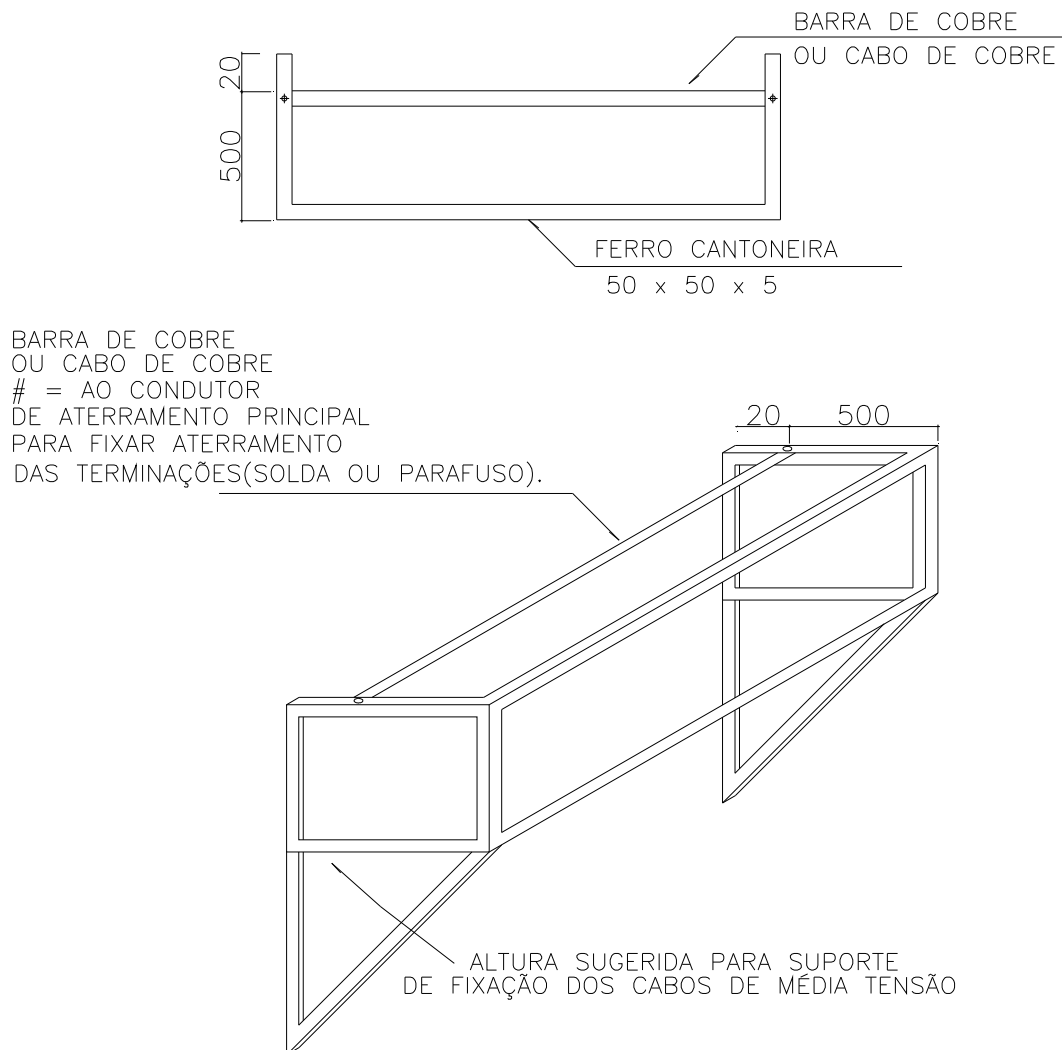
FERRAGEM PARA FIXAÇÃO DE CABOS DE MT COM CHUMBADOR ROSQUEÁVEL
